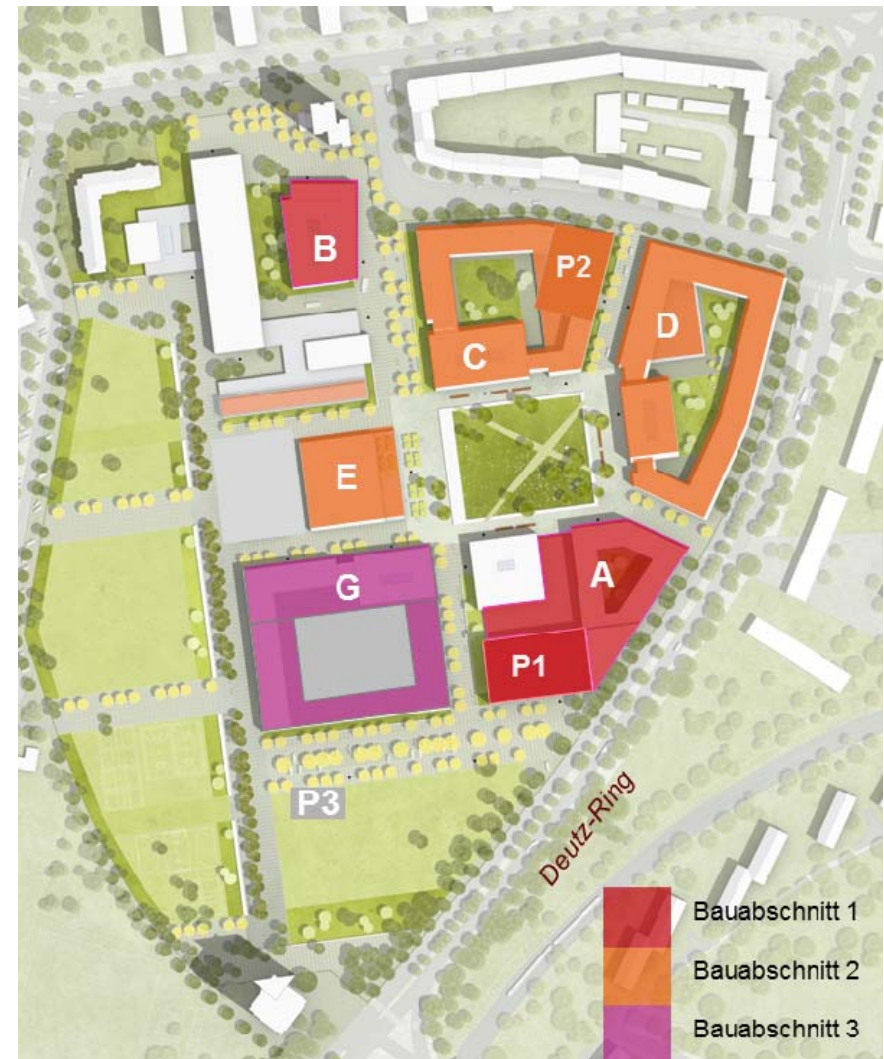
Ersatzneubau Campus Deutz, Bauphasen, Quelle Masterplan, Darstellung TH Köln.
